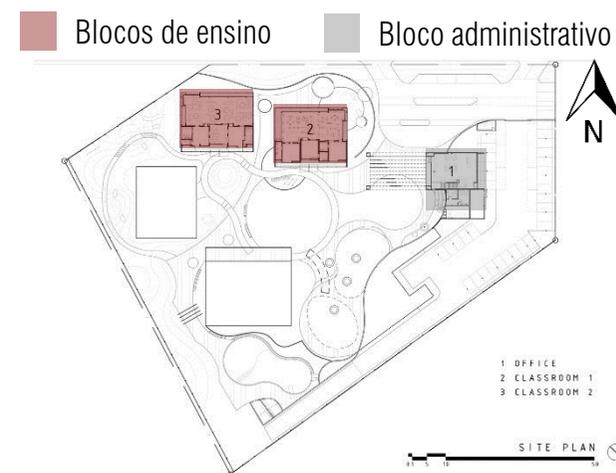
Implantação. Fonte: *ArchDaily* (2018).
